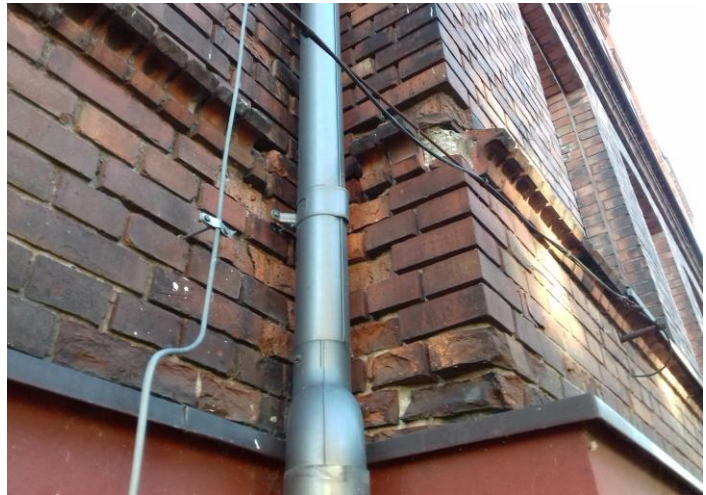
Elewacja szczytowa od strony wejścia –widok dolnej części .
